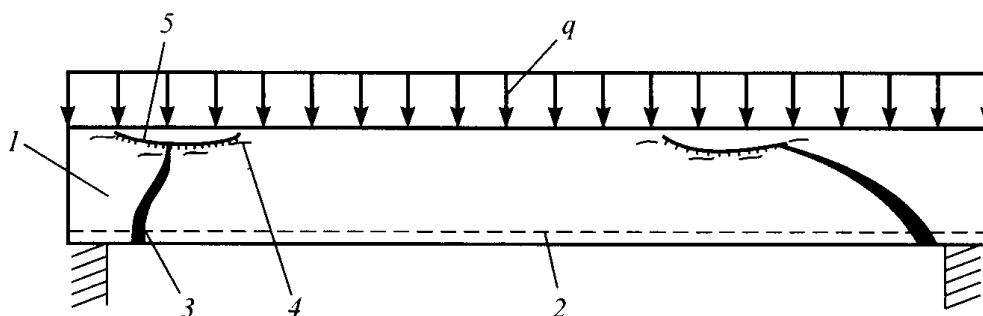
Оценка по раскрытию трещин и раздроблению бетона в наклонном сечении:
